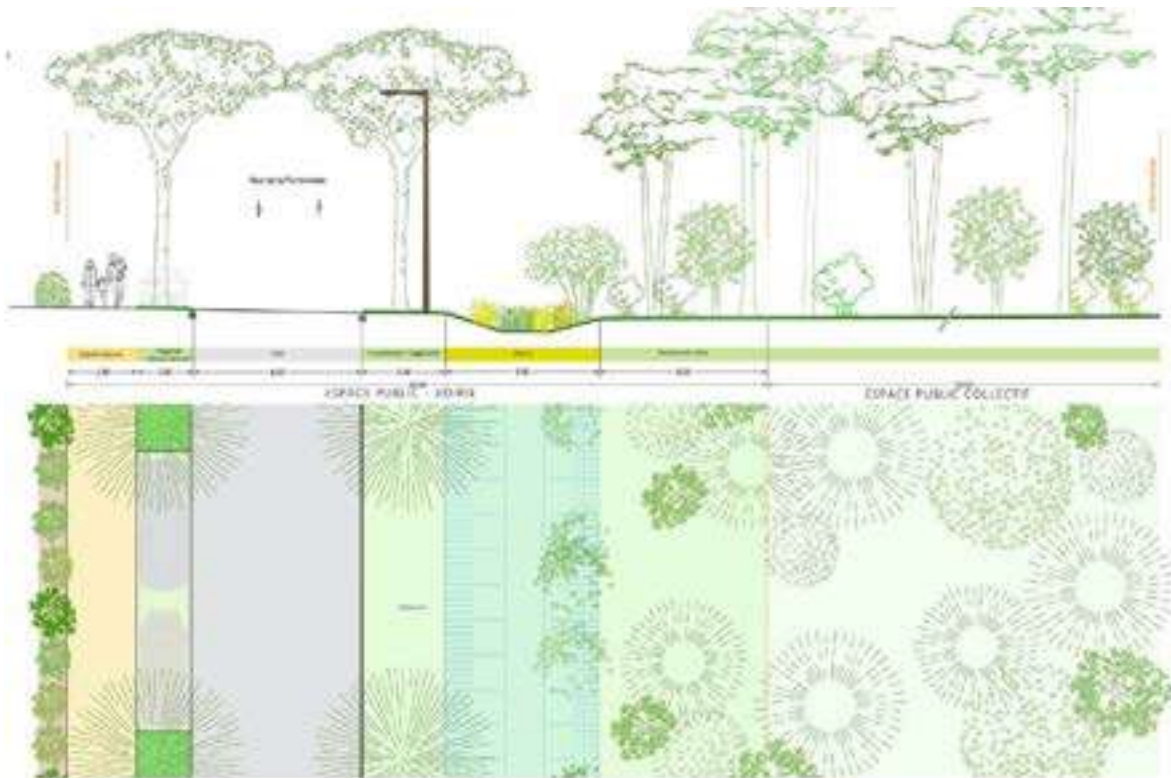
Plan en coupe de la rue de la Ferronnerie projetée (Source : VERDI)
